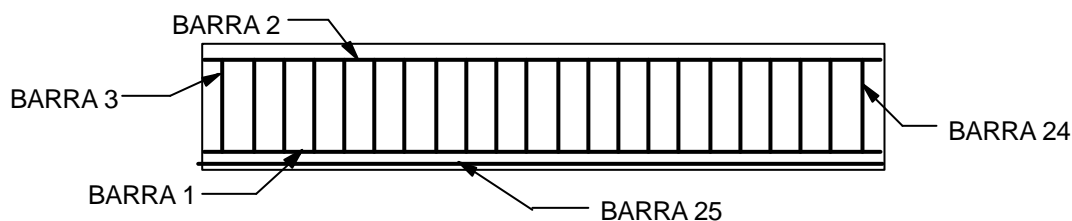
Discretização da armadura da viga reforçada com chapa de aço
